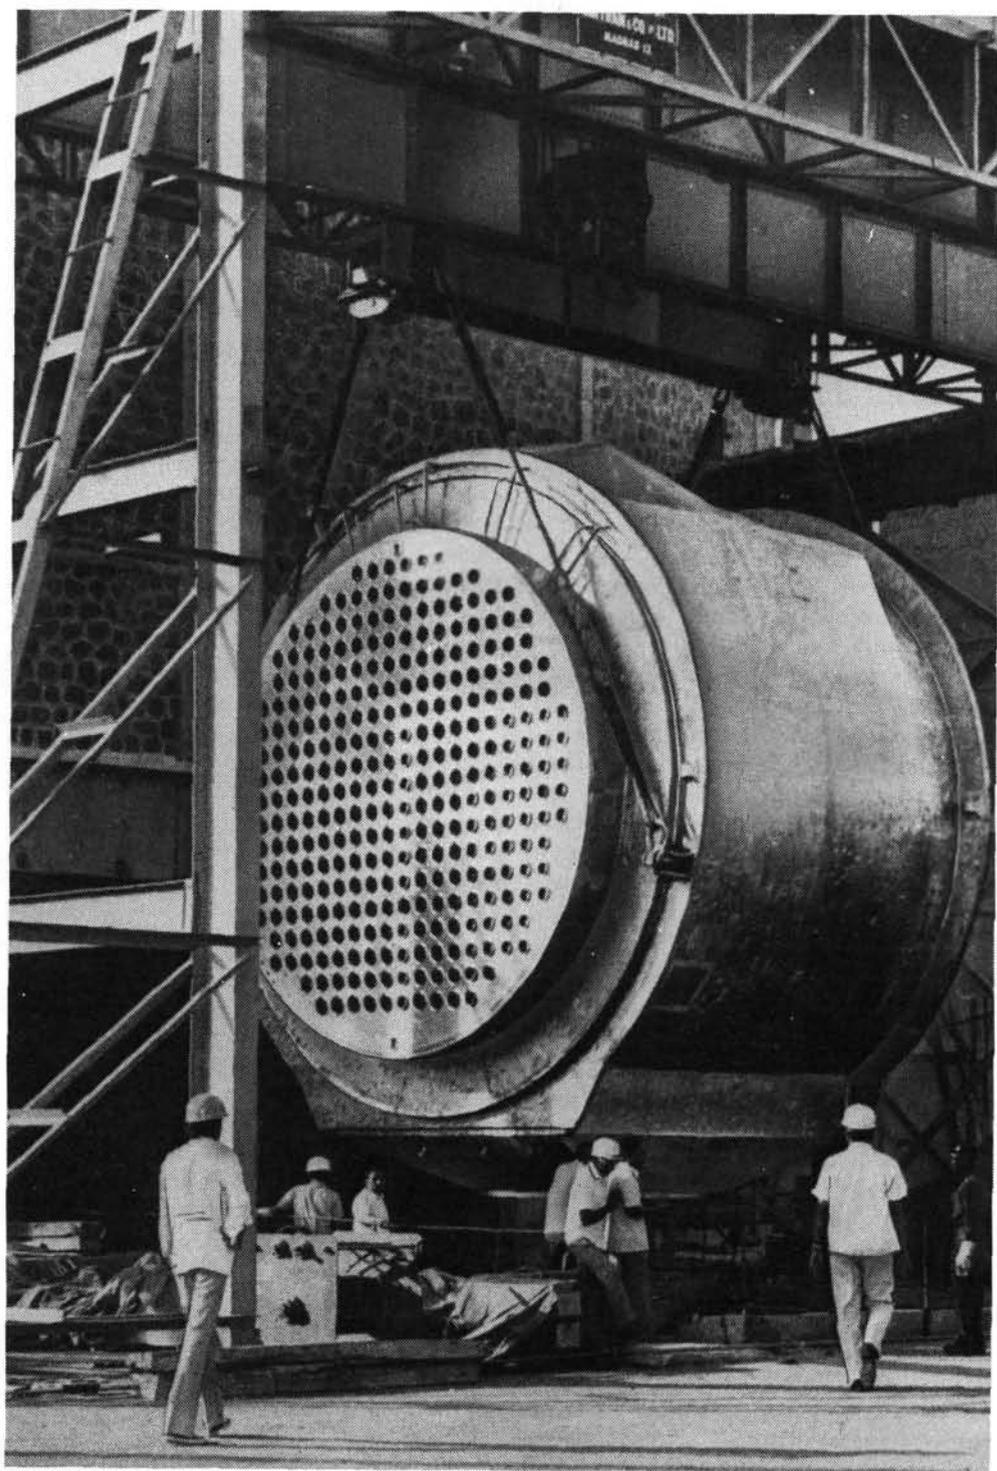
Installation à la centrale nucléaire de Madras d'une calandre fabriquée en Inde.
